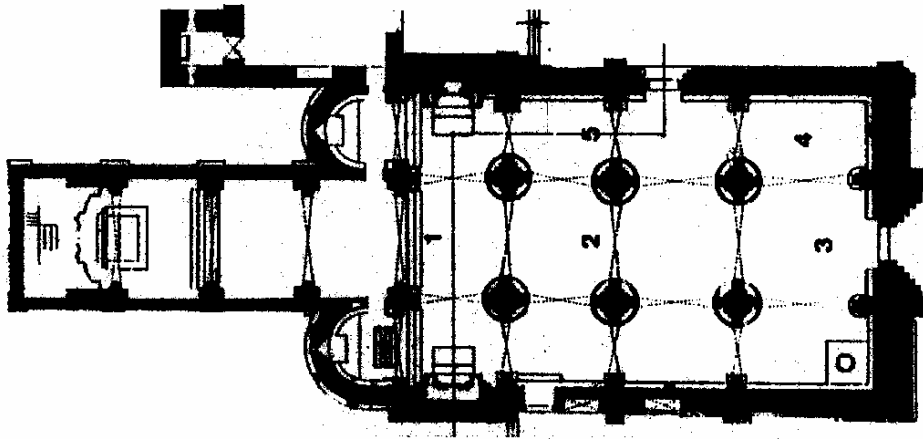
Planta da igreja do Salvador (Paço de Sousa) [3]
